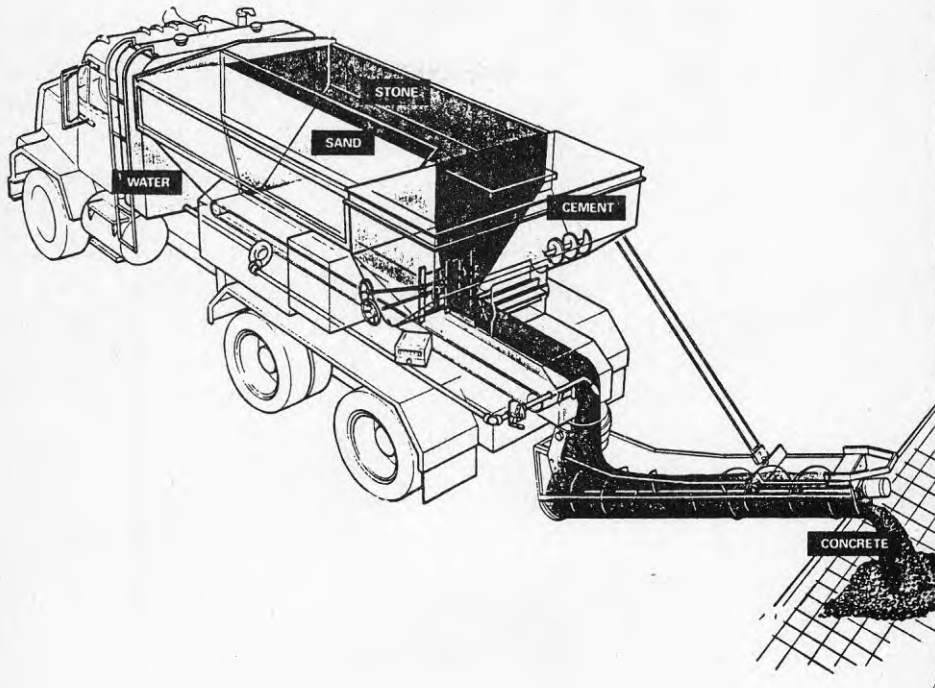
Den här betongbilen är t o m sin egen betongstation.
